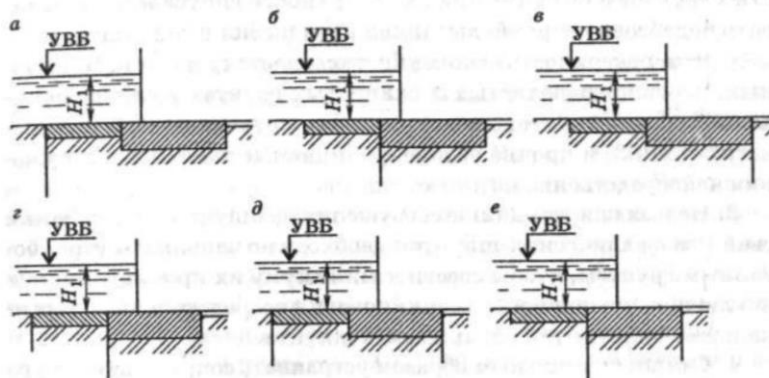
Схемы расположения шпунтовых стенок в подземном контуре:
